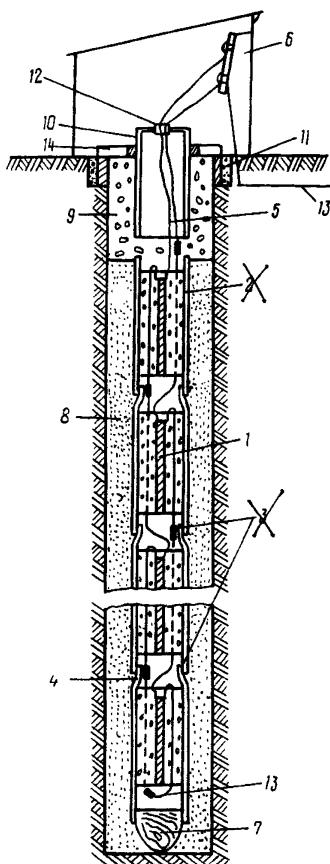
Общий вид глубинного заземления из заземлителей типа АК-2Г:
